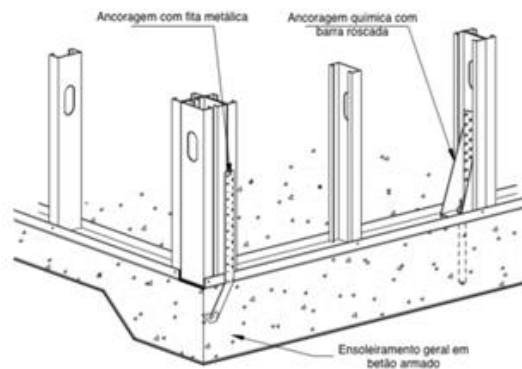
Pormenor dos tipos de ancoragem (Rego, D. Estruturas de Edifícios em LSF) [30]
